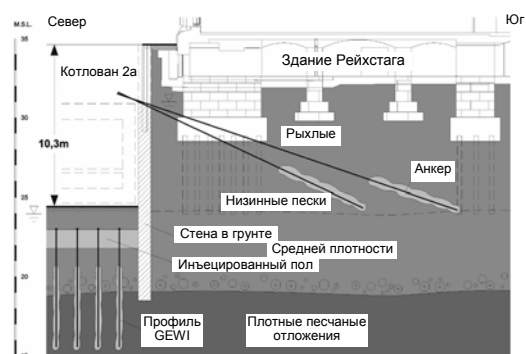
Котлован, связующий туннель и здание Рейхстага
